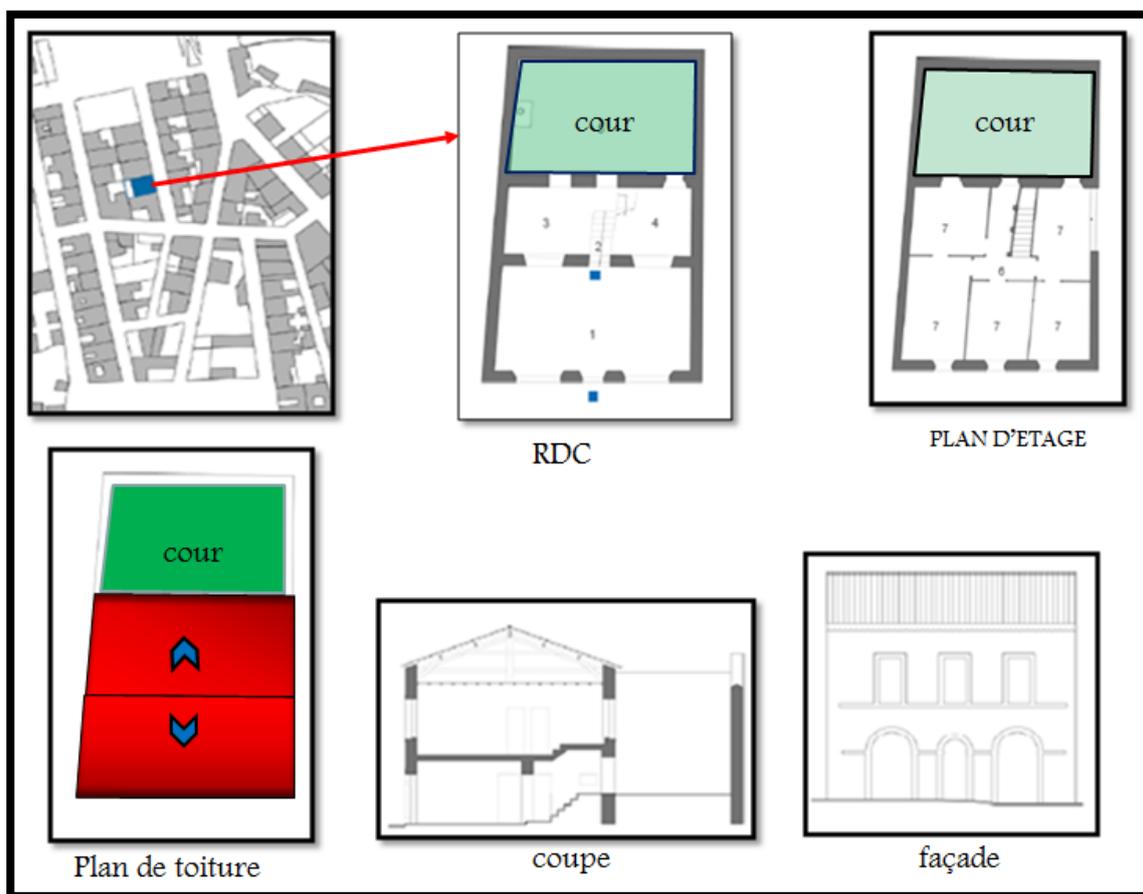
Différents plan, façade et coupe d'une maison coloniale
